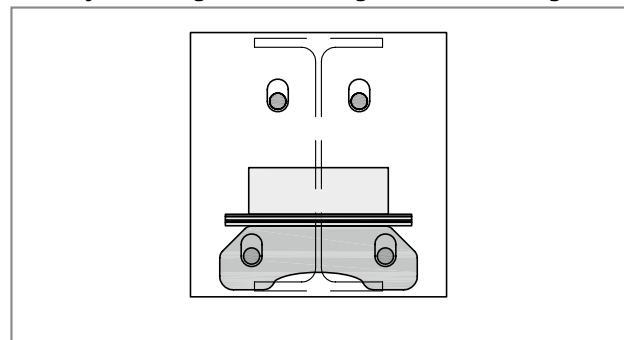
Schöck Isokorb®: Anschluss Stahl – Stahlbeton; Distanzplättchen auf der Lastaufnahmeplatte erhöhen die Lage des Stahlträgers um bis zu 20 mm
